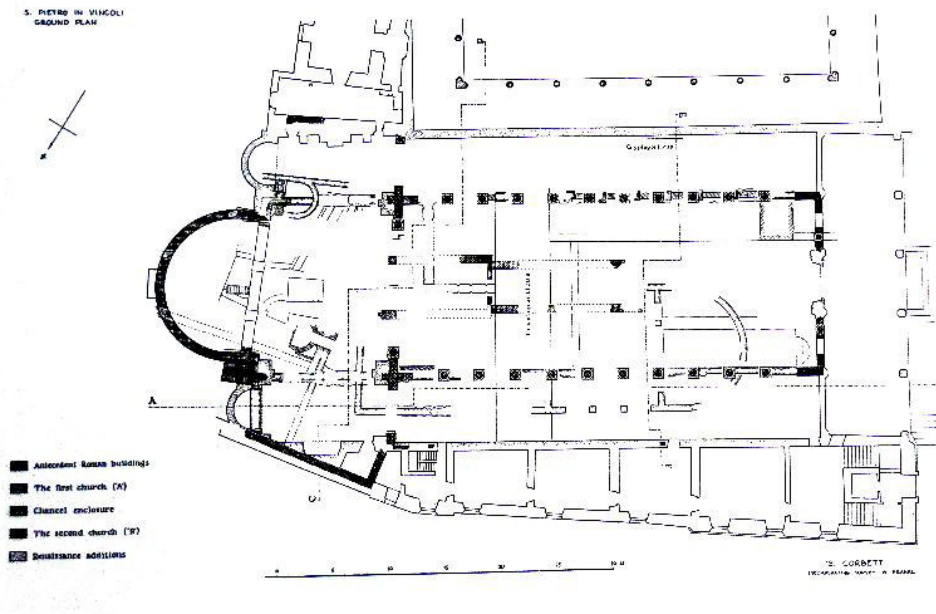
s. Pietro in Vincoli. Planimetria (Krautheimer 1967)
